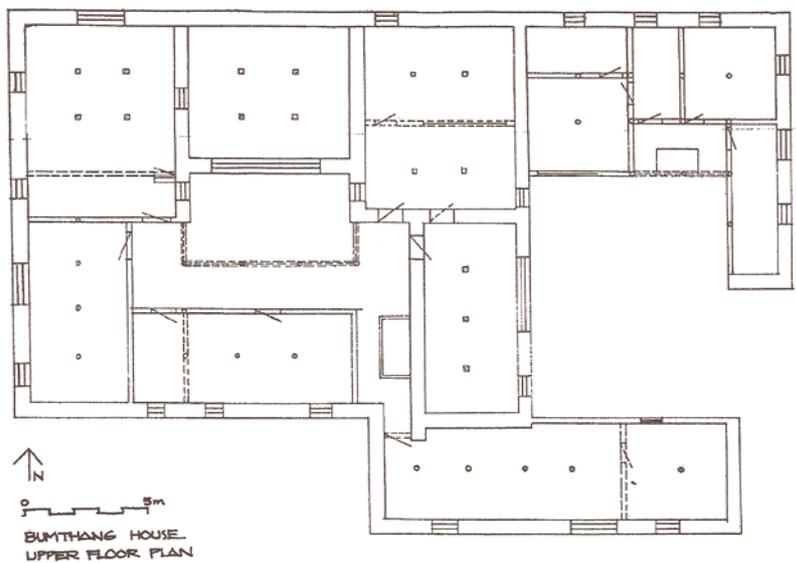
Chongye Bumthang, Lhasa, Grundriss 1. Stock (Alexander/de Azevedo 1998)
